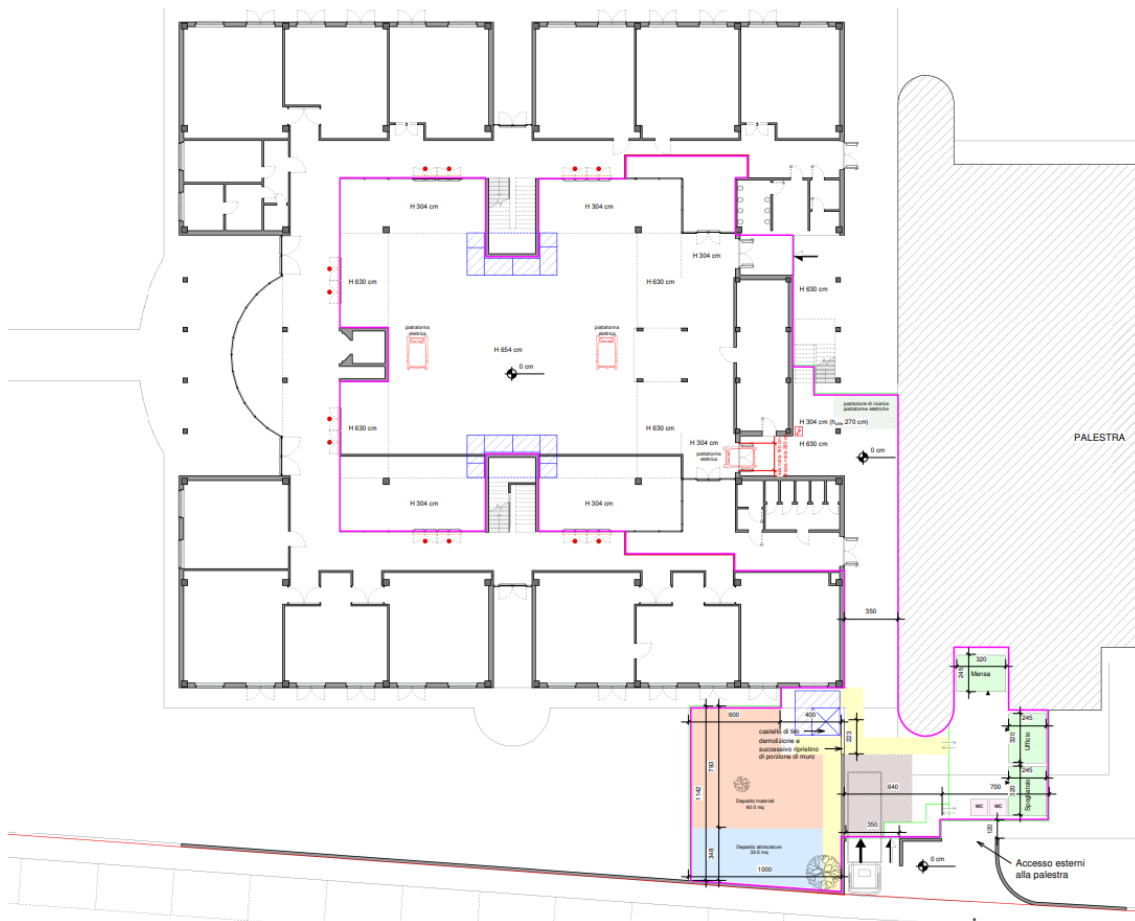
Individuazione dell'area di cantiere - Pianta del Piano Terra
